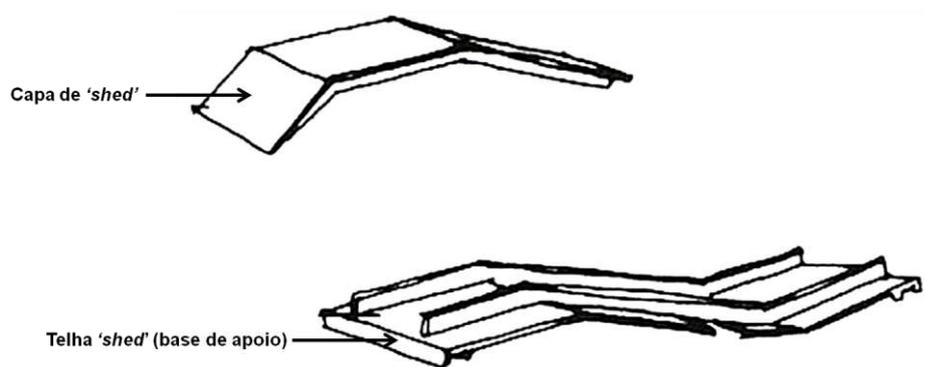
Desenho de Lelé de peças pré-fabricadas para 'telha shed' em argamassa armada.
